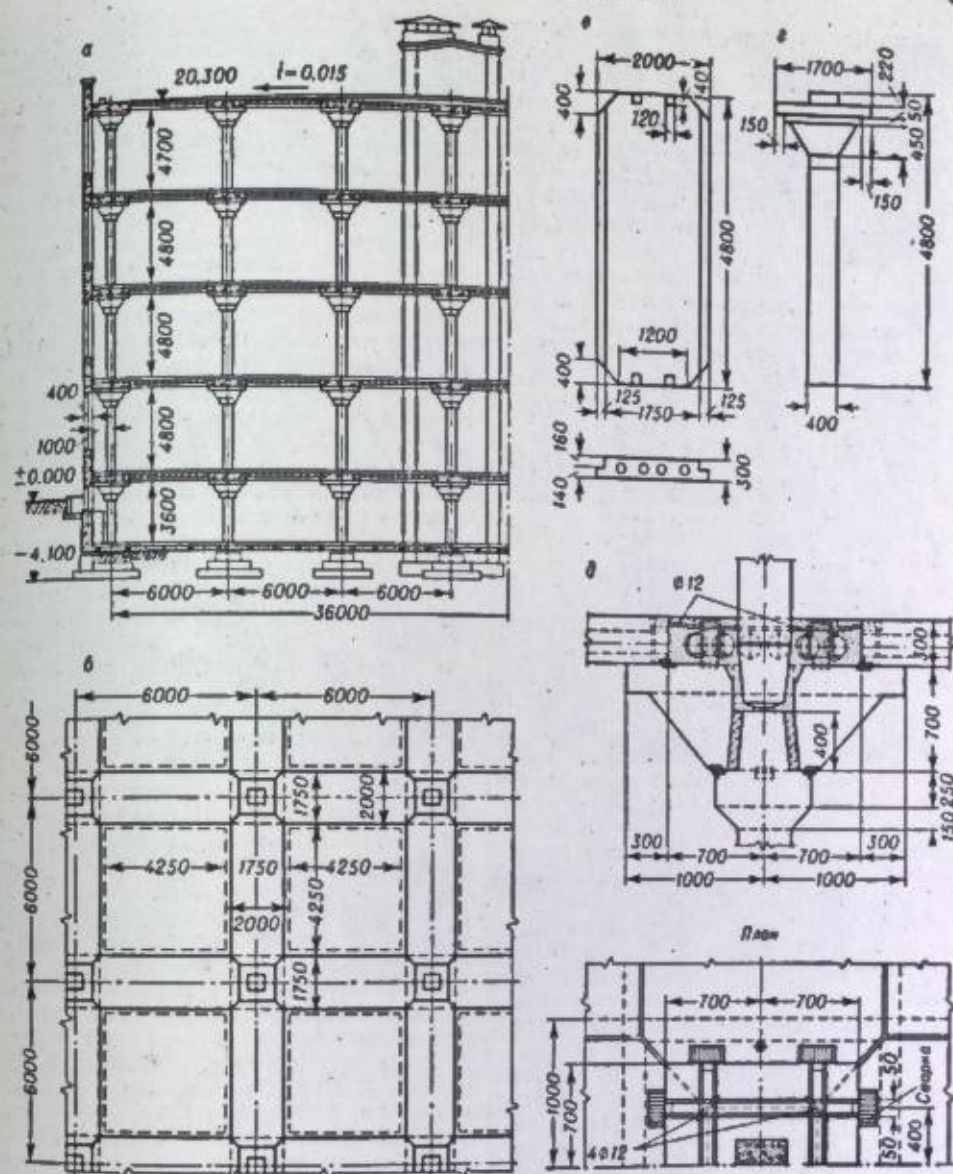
Сборные конструкции многоэтажного здания безбалочной схемы: а — поперечный разрез здания; б — участок плана; в — балка-плита; г — колонна; д — надколонный узел (Промстройпроект).
